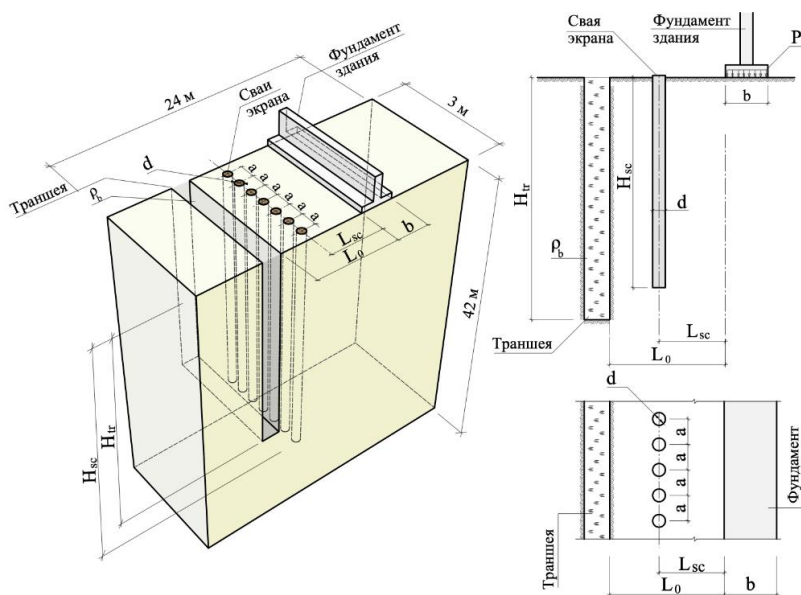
Расчетная схема к задаче о влиянии применения экрана из разреженного ряда свай, на осадки рядом расположенного здания, вызванные разработкой траншеи под «стену в грунте».
